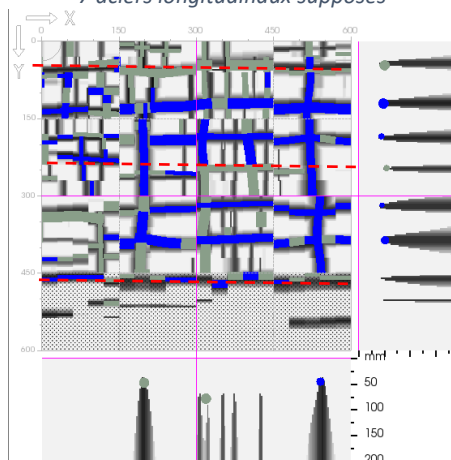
Poutre Pt04 – Travée 4 à mi-travée
